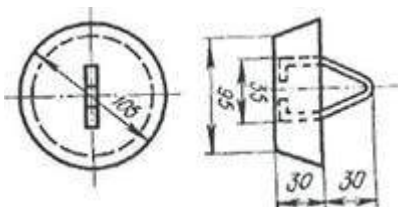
Бетонная пробка для закрытия канала трубопровода связи
